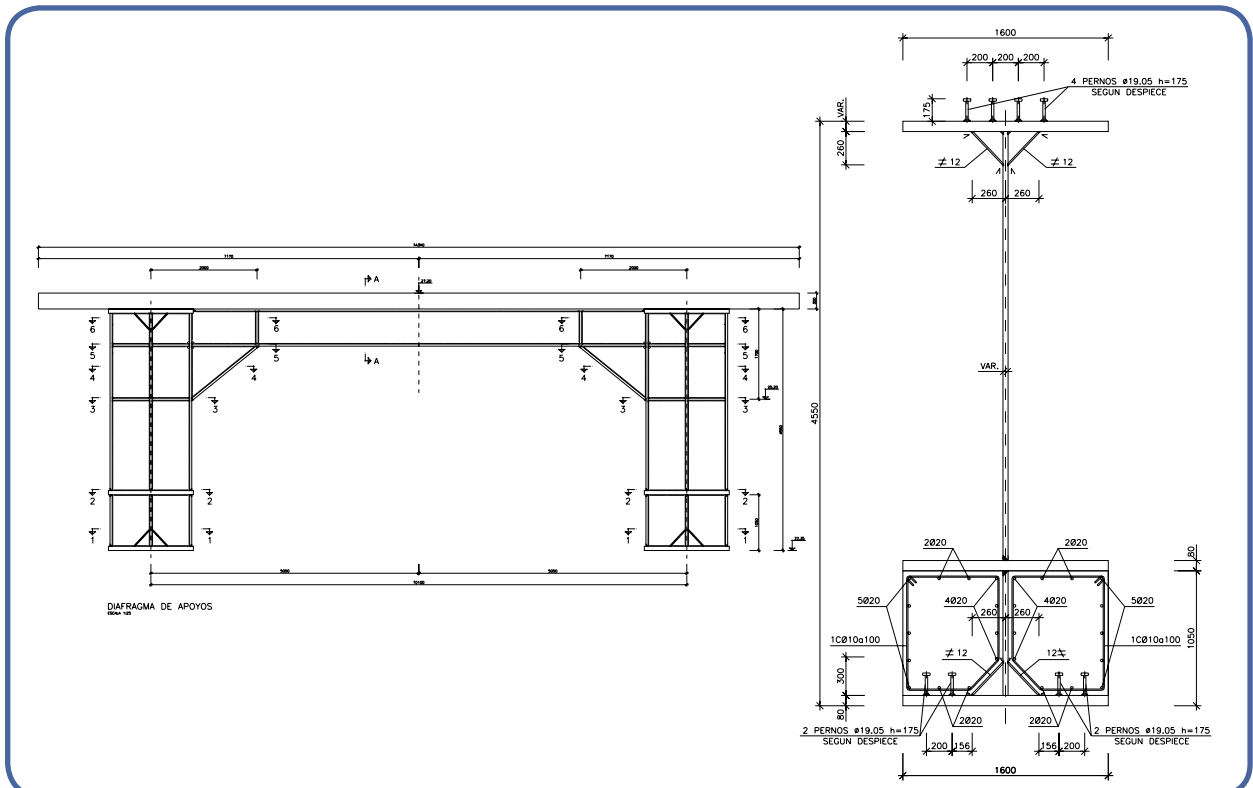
Sección transversal en la zona de apoyos, con la parte inferior libre para dejar paso a la escalera y el ascensor
